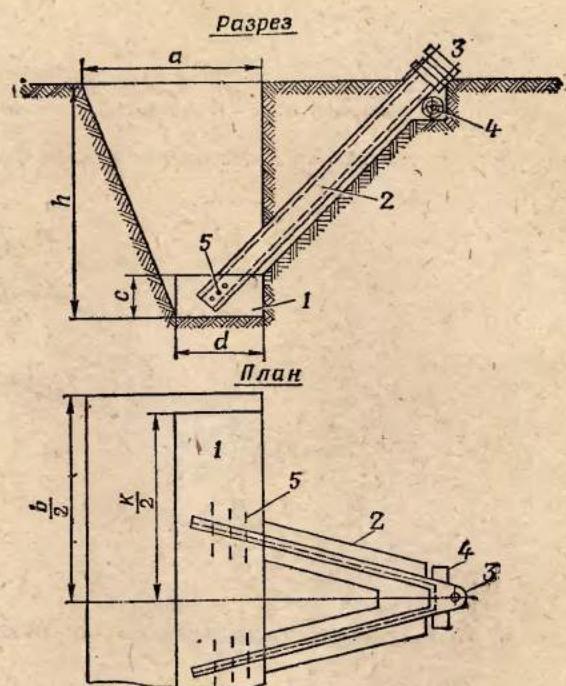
Железобетонный береговой якорь (типовые размеры даны в табл. 24):
